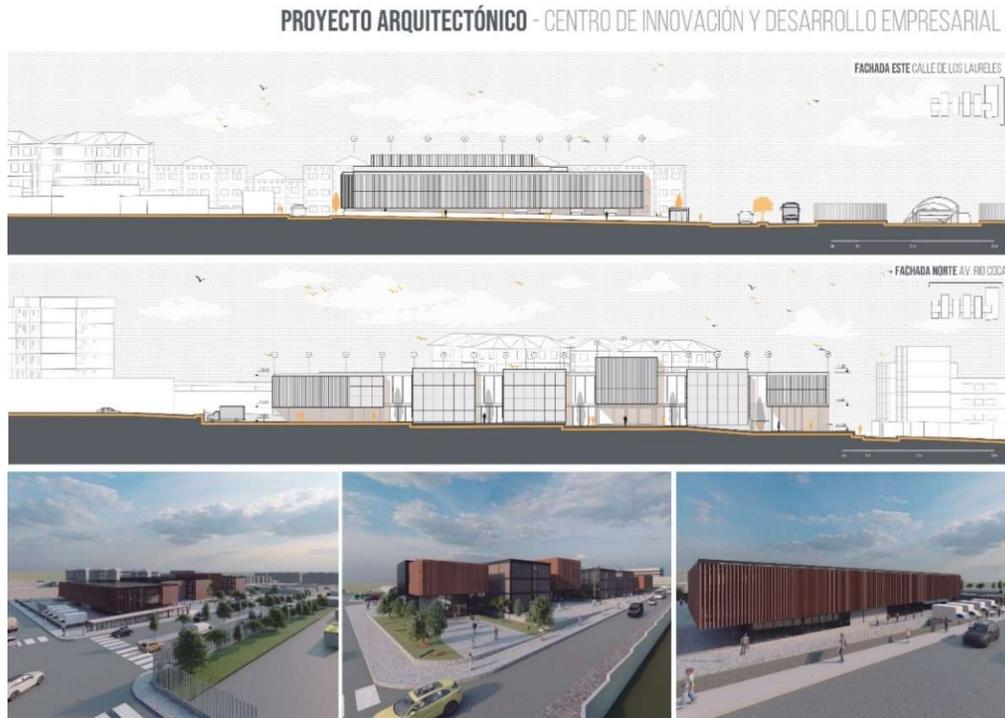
Fachada este, Fachada norte y Renders exteriores. Elaborado por: Andrés
